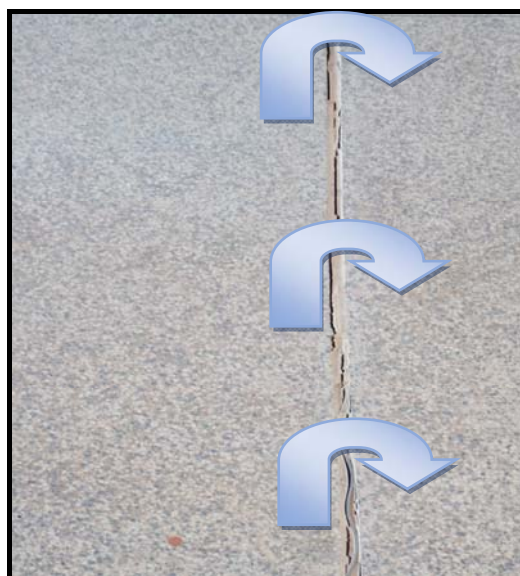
Vista de fissuras do pavimento do terminal de passageiros decorrente do assentamento de solos à direita da imagem. Fonte: DNIT (2014)
